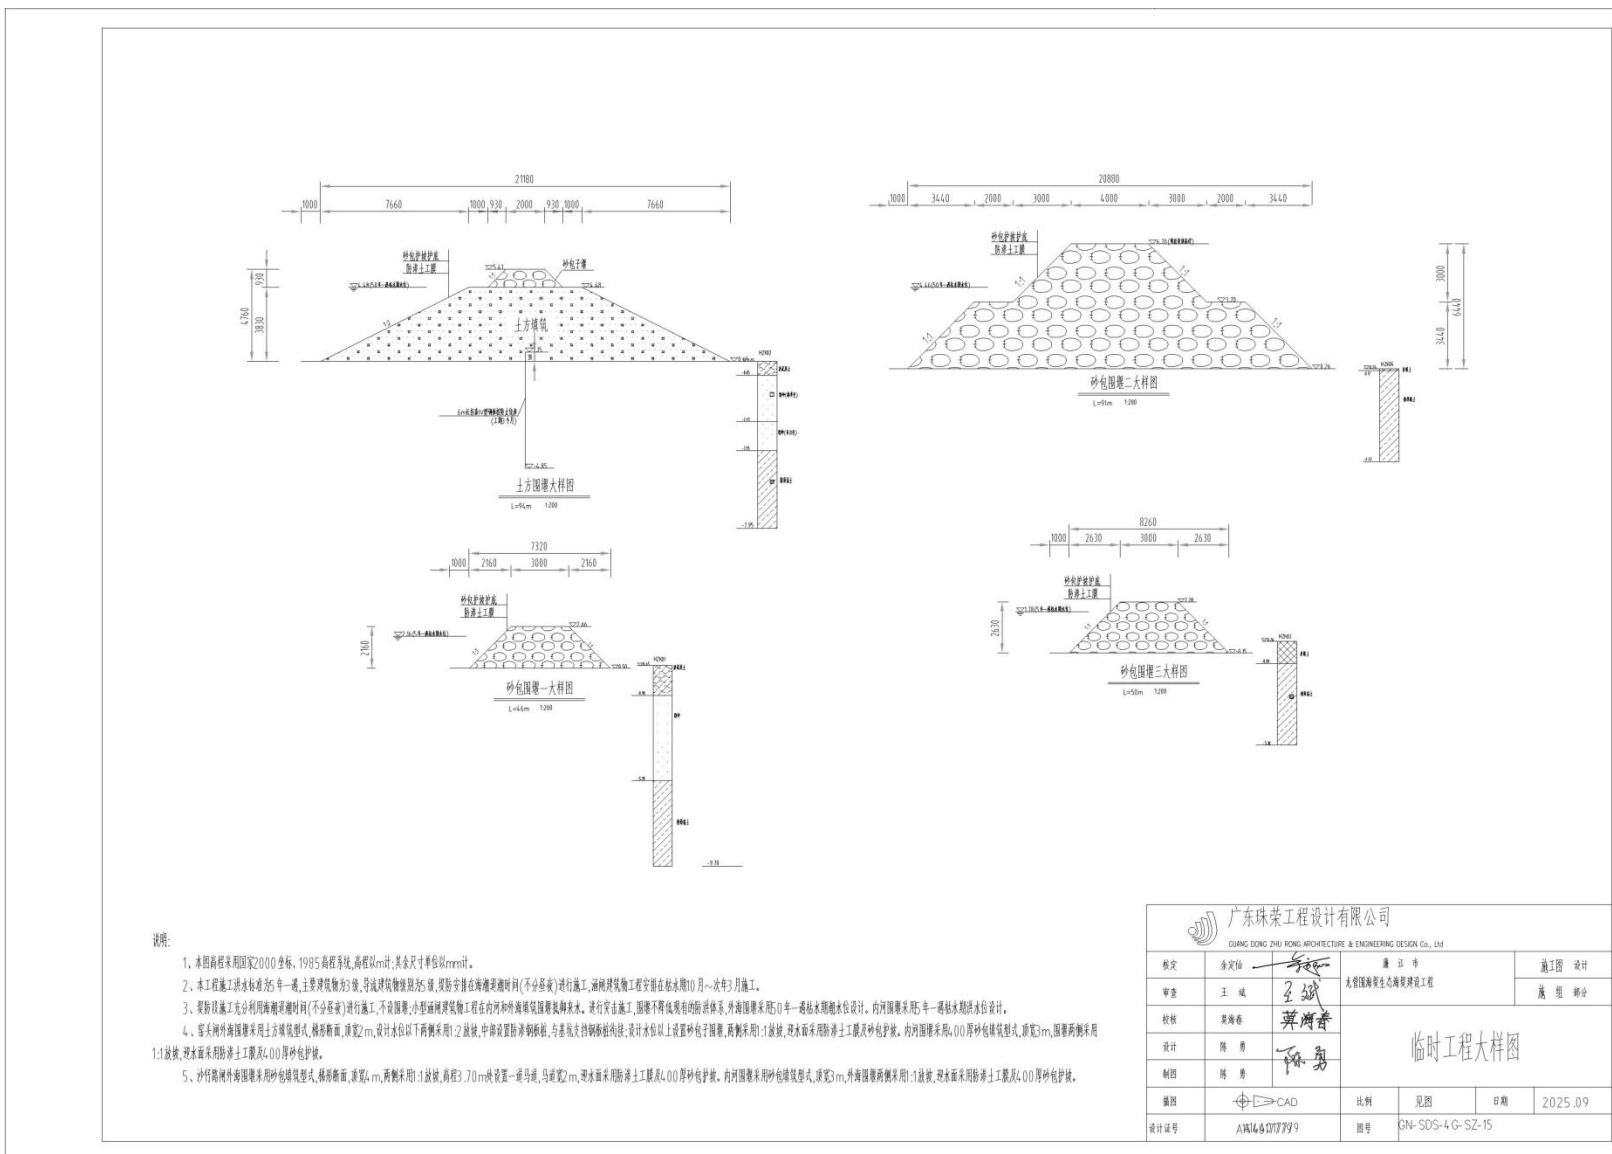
施工期围堰大样图 (断面示意图)
